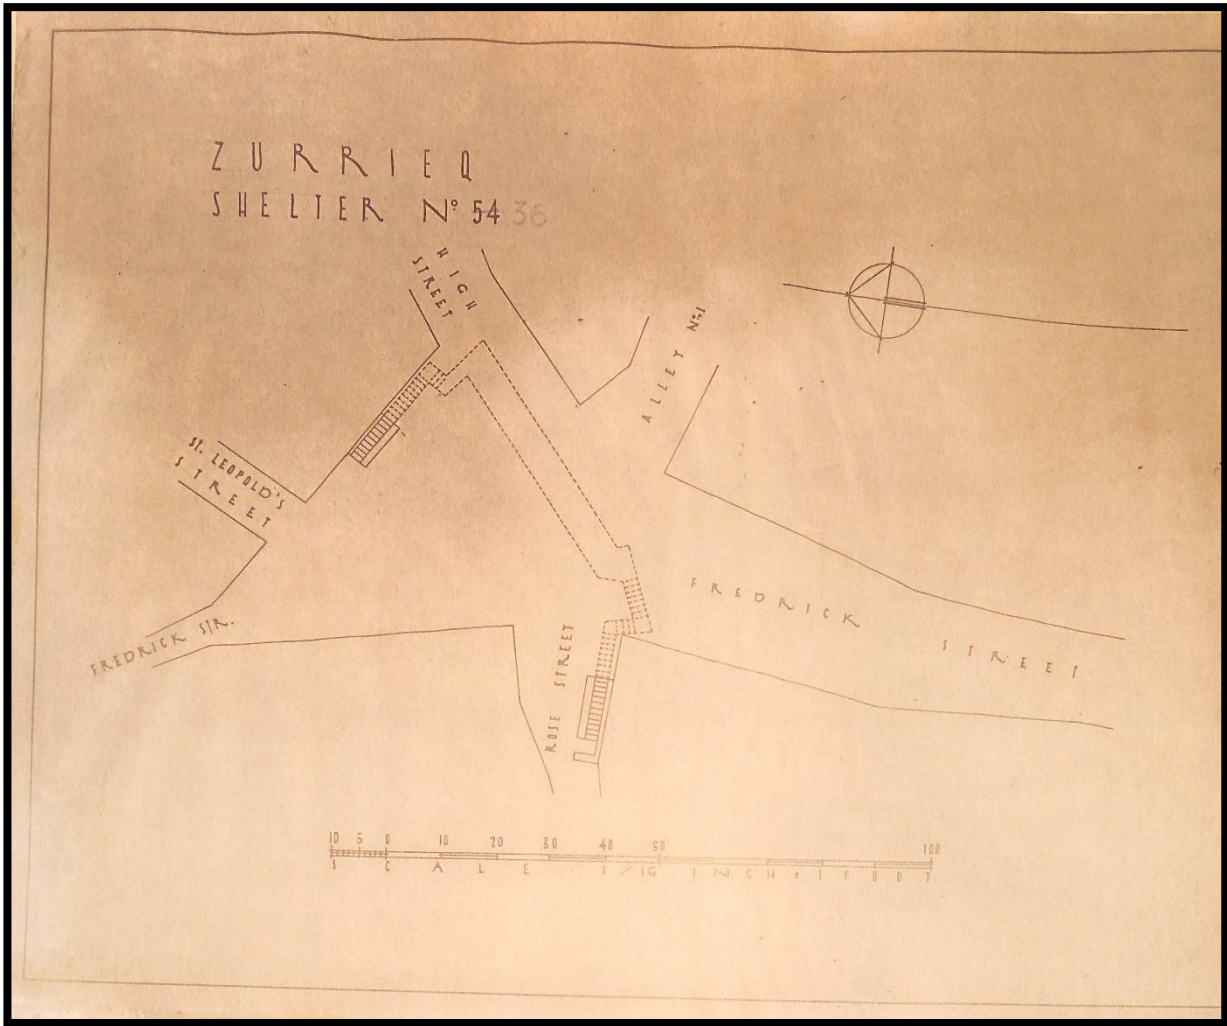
Planta do Abrigo nº54 (36) "Fredrick Str. – St. Leopold's Street – High Street – Alley nº1 -Rose Street – Frederick Street."
